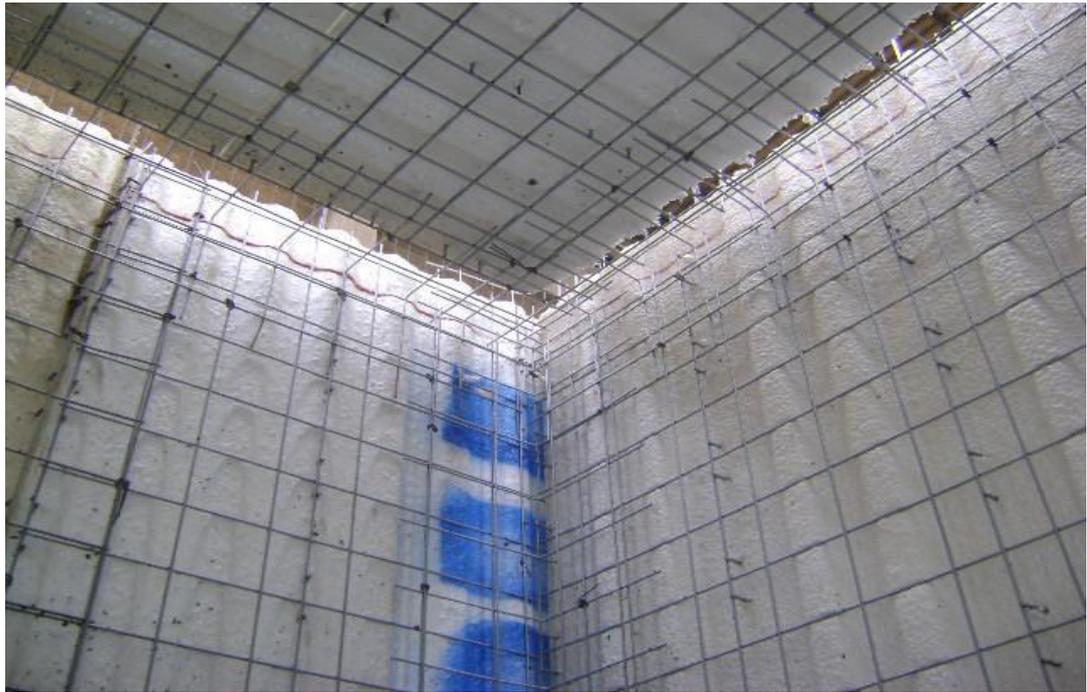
Etapa 03. Imagen real en obra del montaje del panel losa al panel muro, anclada las mallas angulares, tanto interior como exterior.
